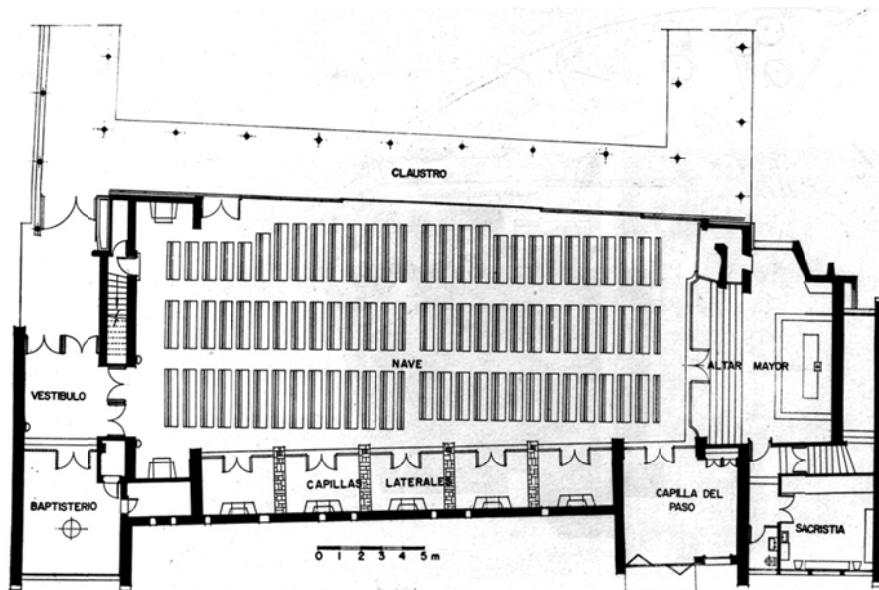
Planta de la Iglesia (Torroja, E. 1962)
